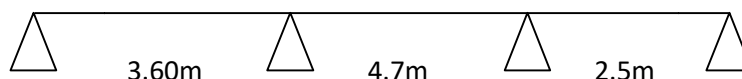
Schéma statique de la poutrelle à 3 travées.
